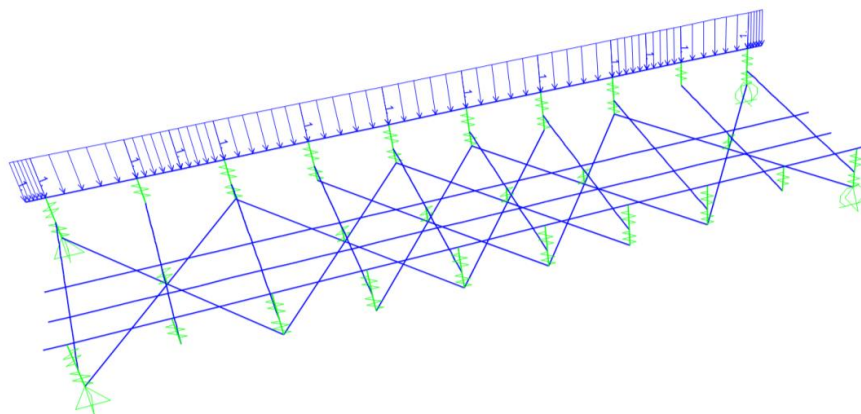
Modello FEM: carico uniforme sui traversi – barriere e parapetti
